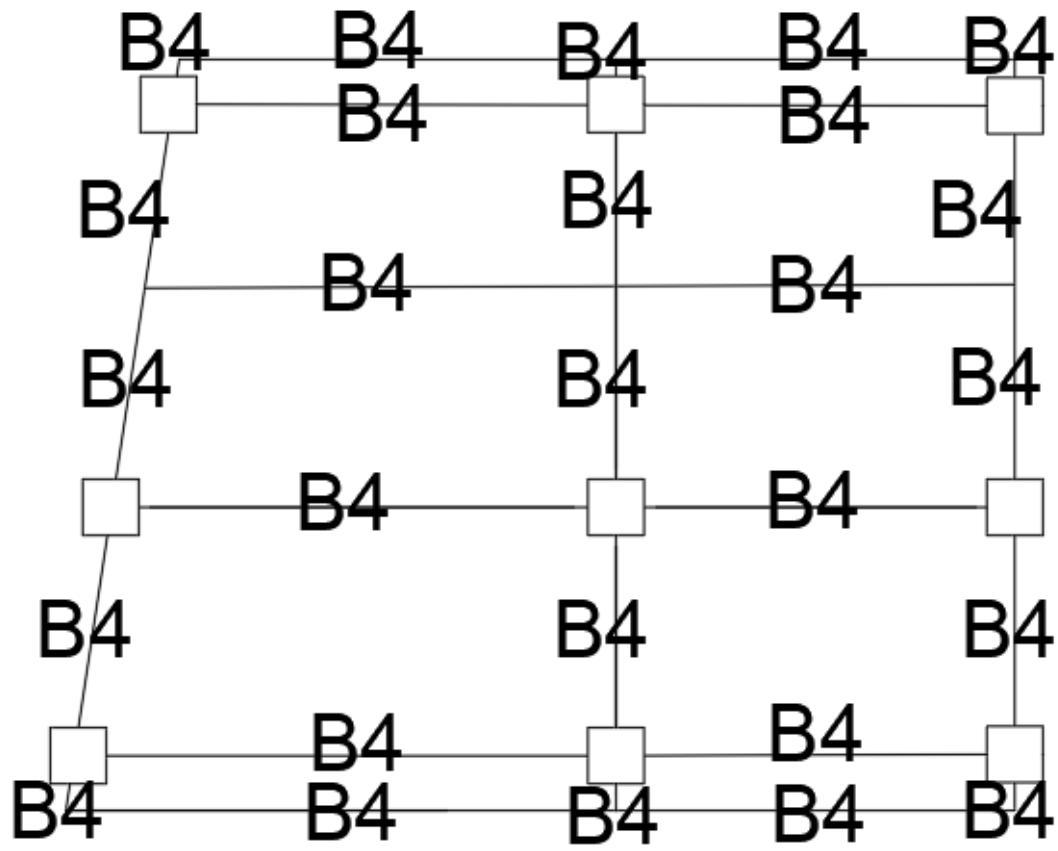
Denah *Final* Balok Bangunan B.1
